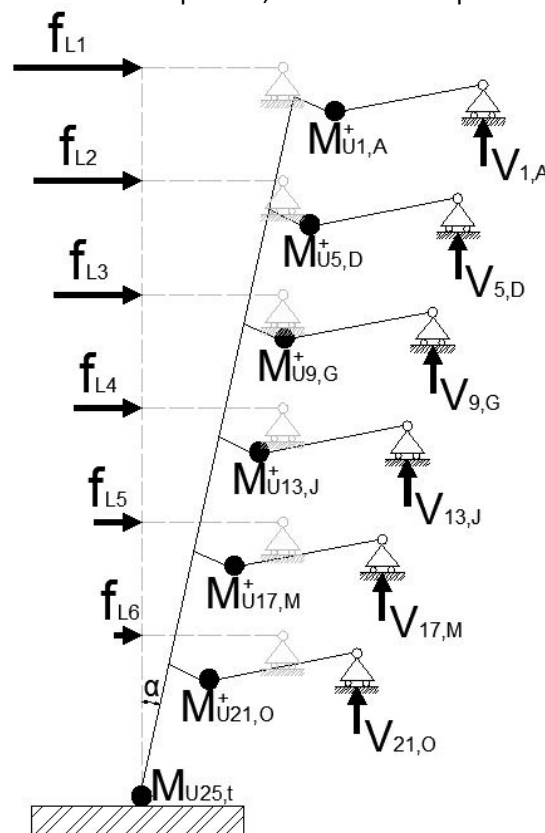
Análisis plástico de columna izquierda del pórtico 1. Pilar 1
